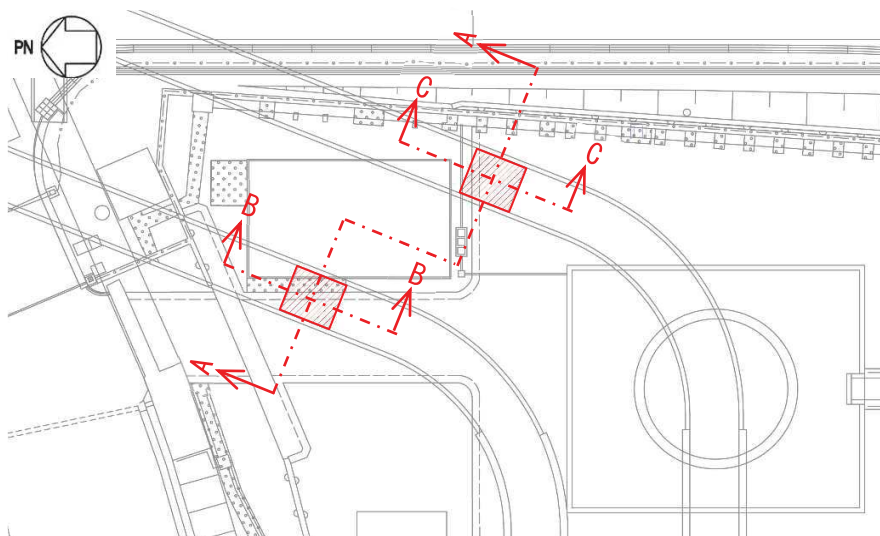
取放水路流路縮小工（第1号機取水路）（No.1），（No.2）の平面配置図
